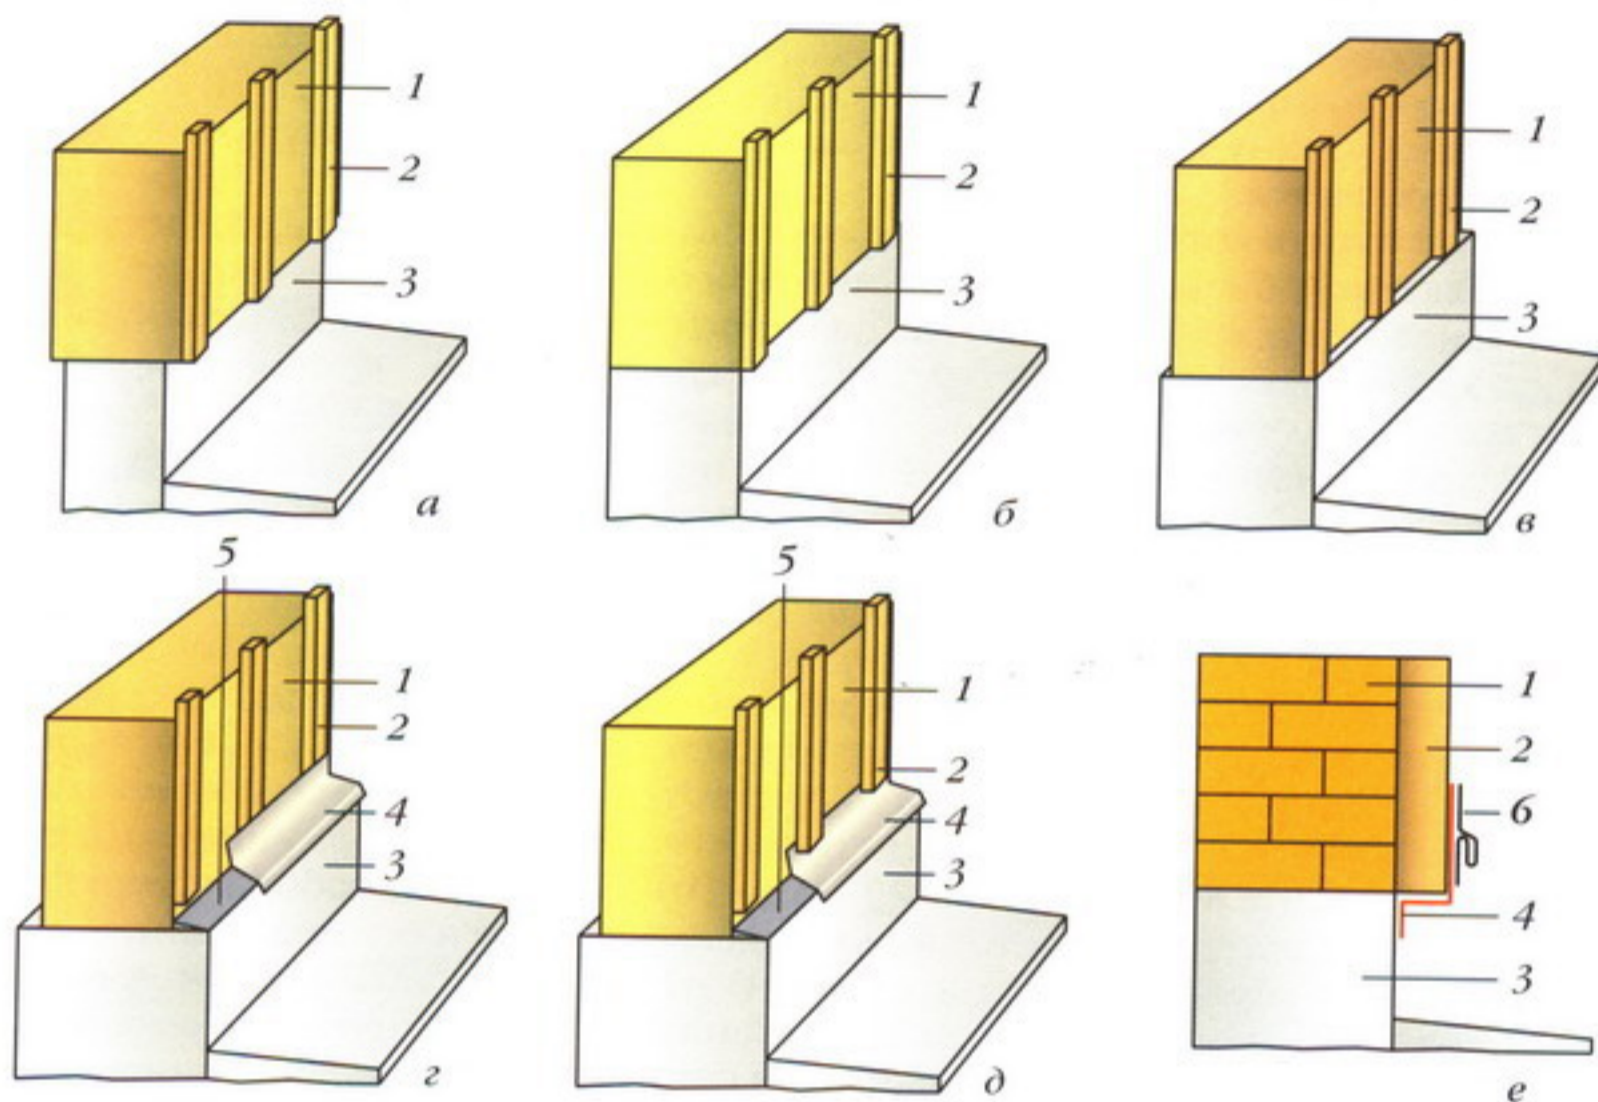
Виды цоколей: а — западающий; б — ровный; в — выступающий (выровненный обрешеткой со стеной); г — выступающий с отливом поверх обрешетки; д — то же, с отливом по стене; е — цоколь с защитой от грызунов; 1 — стена; 2 — обрешетка; 3 — цоколь; 4 — стальной или виниловый отлив; 5 — цементная стяжка; 6 — стартовая полоса
